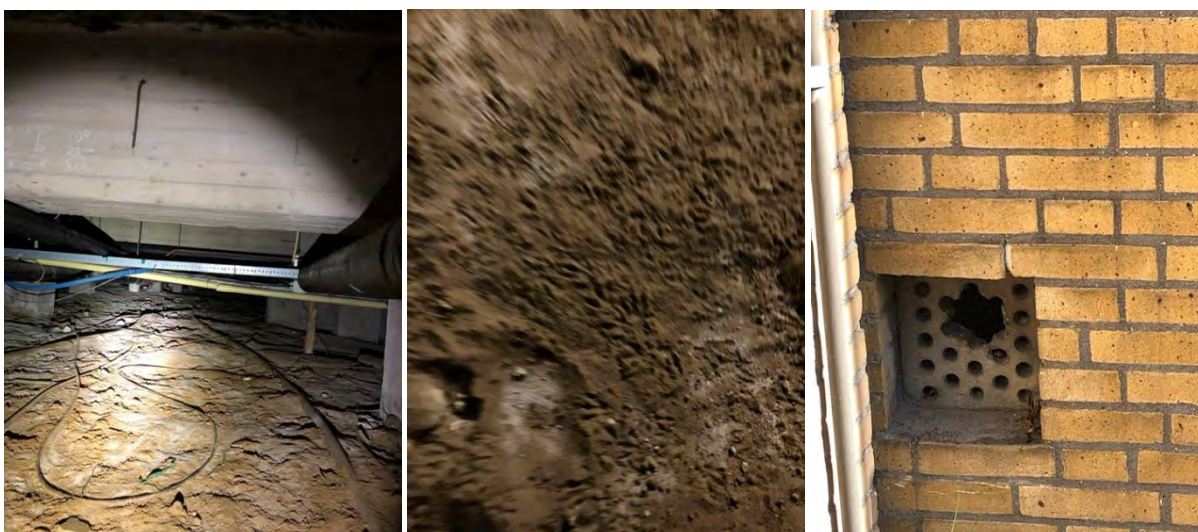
Impressie plangebied en detail stootvoegen en houten bekisten.
